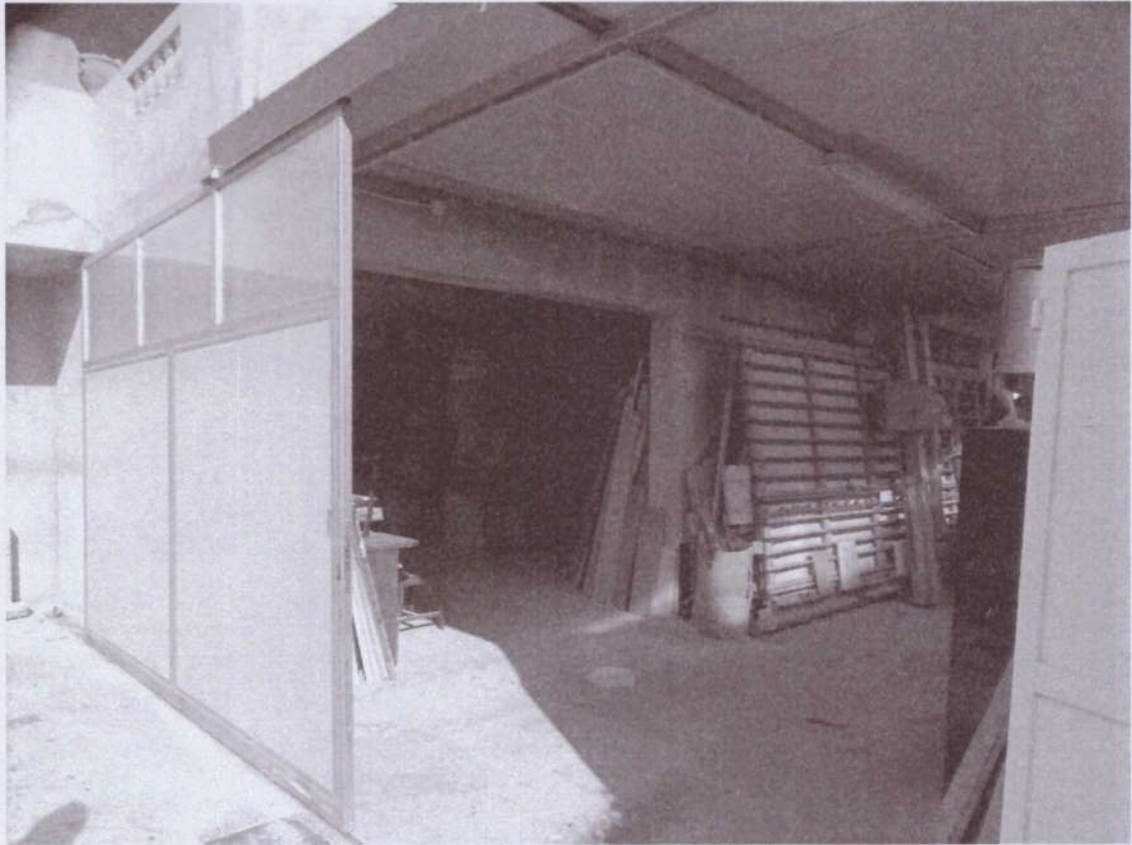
Piano terra – Accesso al Deposito - taglio legname
